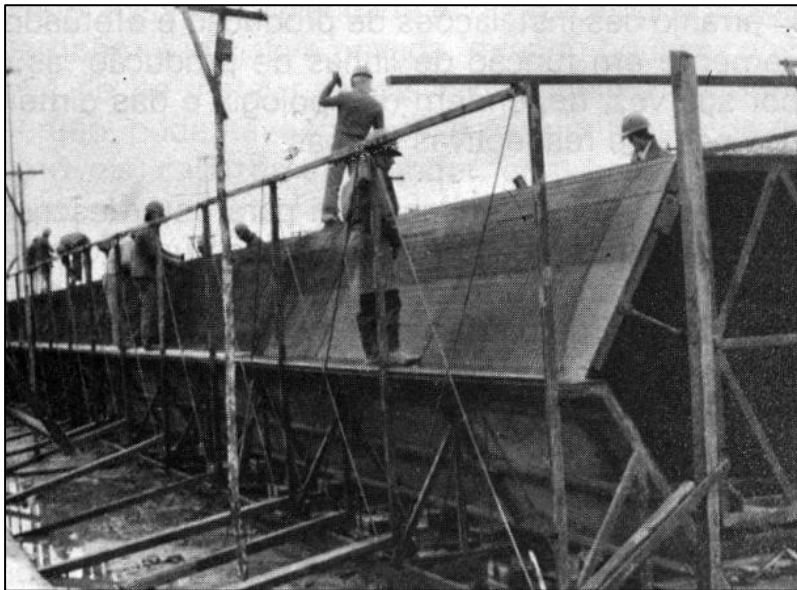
TRRM. Projeto: Brena e Carlevaro [1976] Execução da cobertura. [Fonte: Hanai, 1992]
